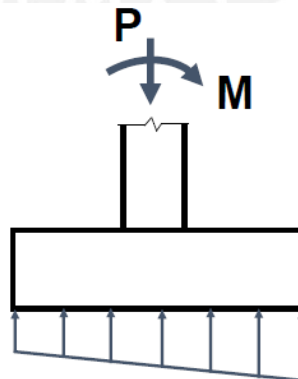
ZAPATA AISLADA EXCÉNTRICA.
